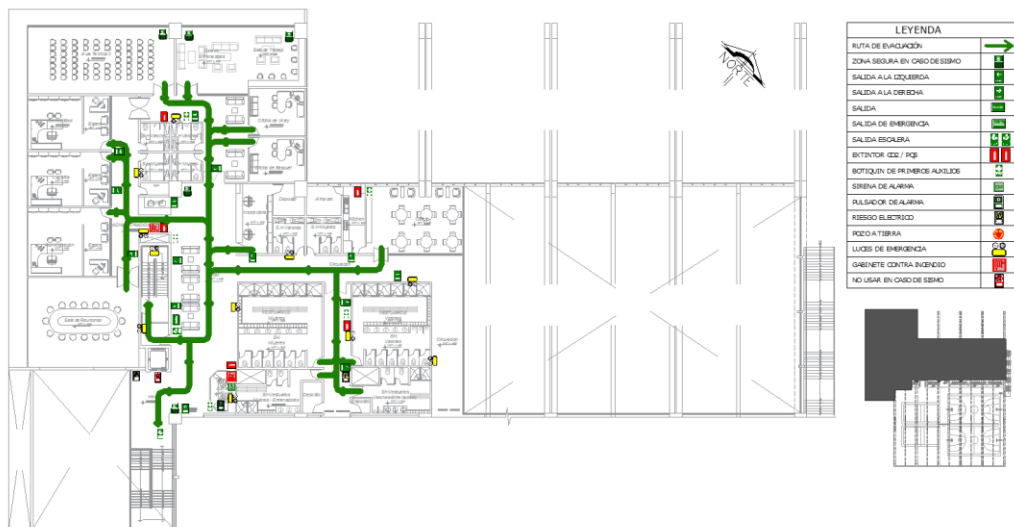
Centro de Masificación Deportiva – Planta 2/ Sector A
